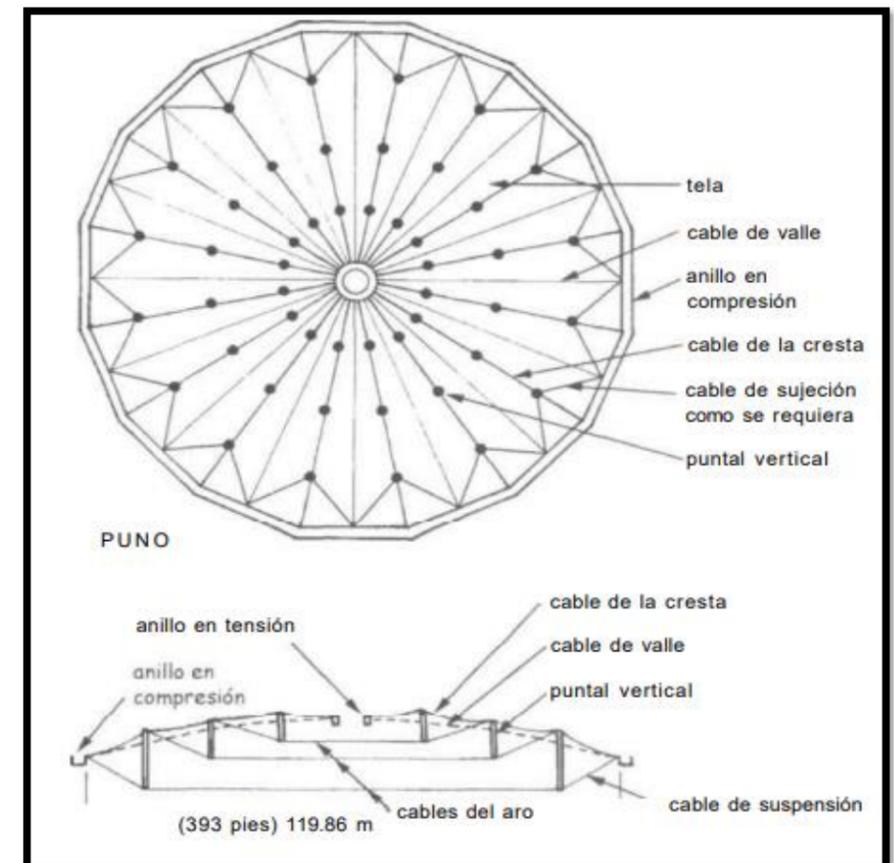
Estadio Olímpico de Gimnasia de Seúl, plano de los cables del techo y diagramas de la sección. Fuente: Comprensión de las estructuras en arquitectura
